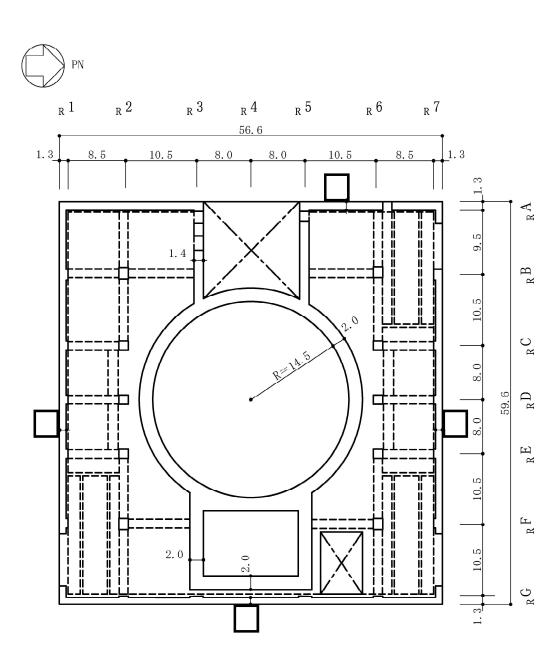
原子炉建屋の概略平面図 (2F, T.M.S.L.18.1m) (5/9) (単位:m)
